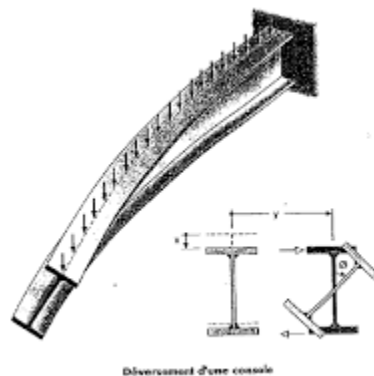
déversement d'une poutre en console travaillant en flexion.
